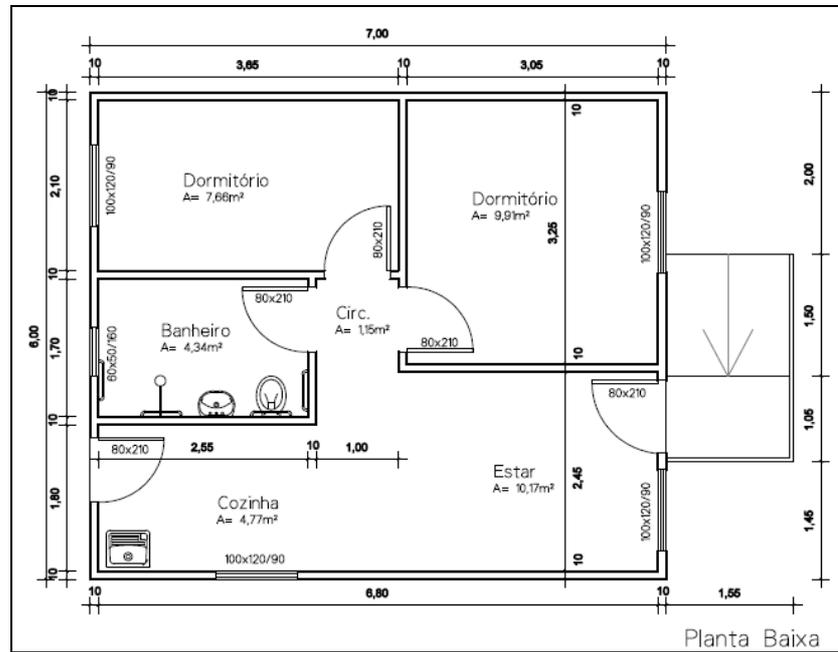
Planta baixa casa térrea – Conjunto Habitacional Padre Orestes – 42,00m²
